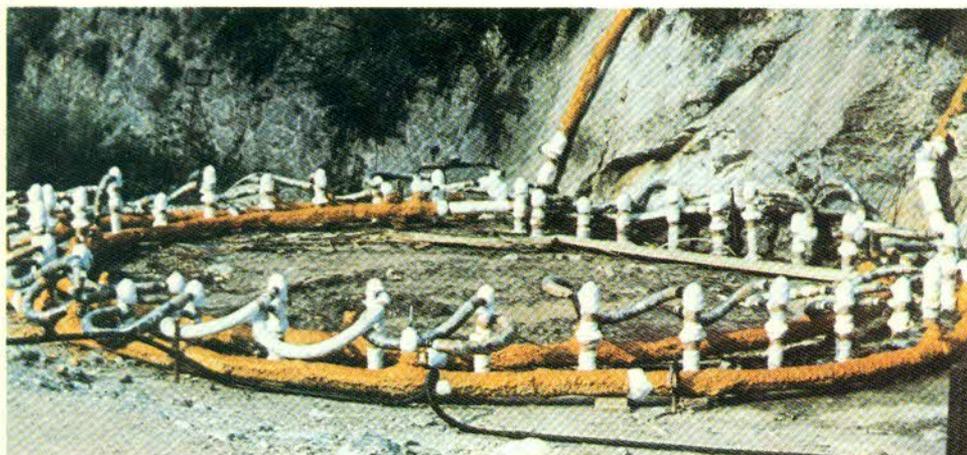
Particolare dell'anello di distribuzione della salamoia alle sonde congelatrici (pozzo n. 33) □ Detail of a circular ring for the distribution of the brine to the refrigeration pipes (well no. 33)
